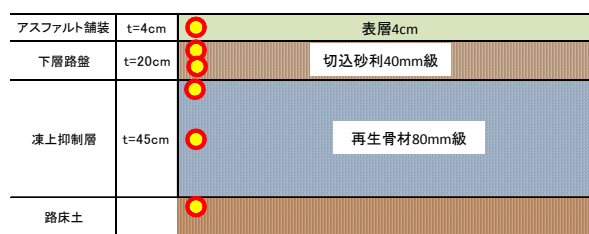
試験施工箇所 (旭川市春光台) 施工時期 H23.11
